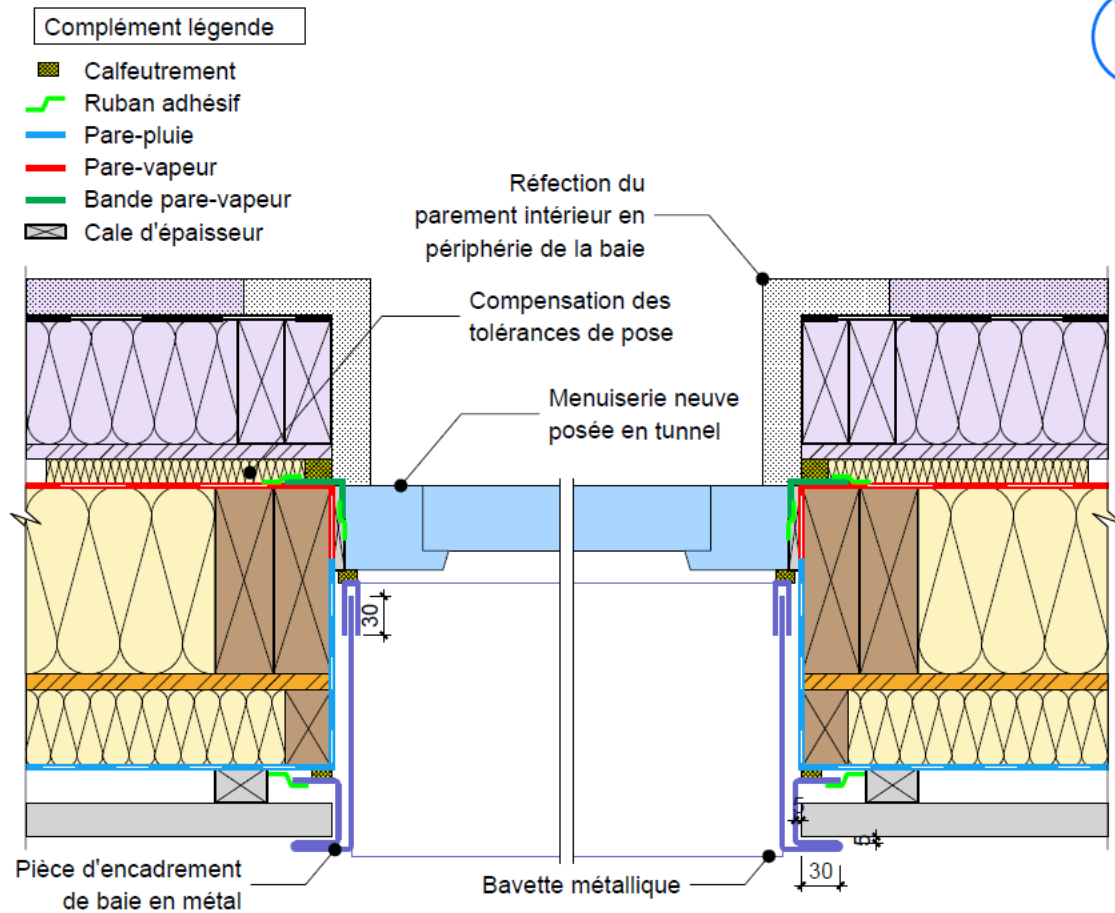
Baie avec encadrement rapporté en métal (coupe horizontale)
